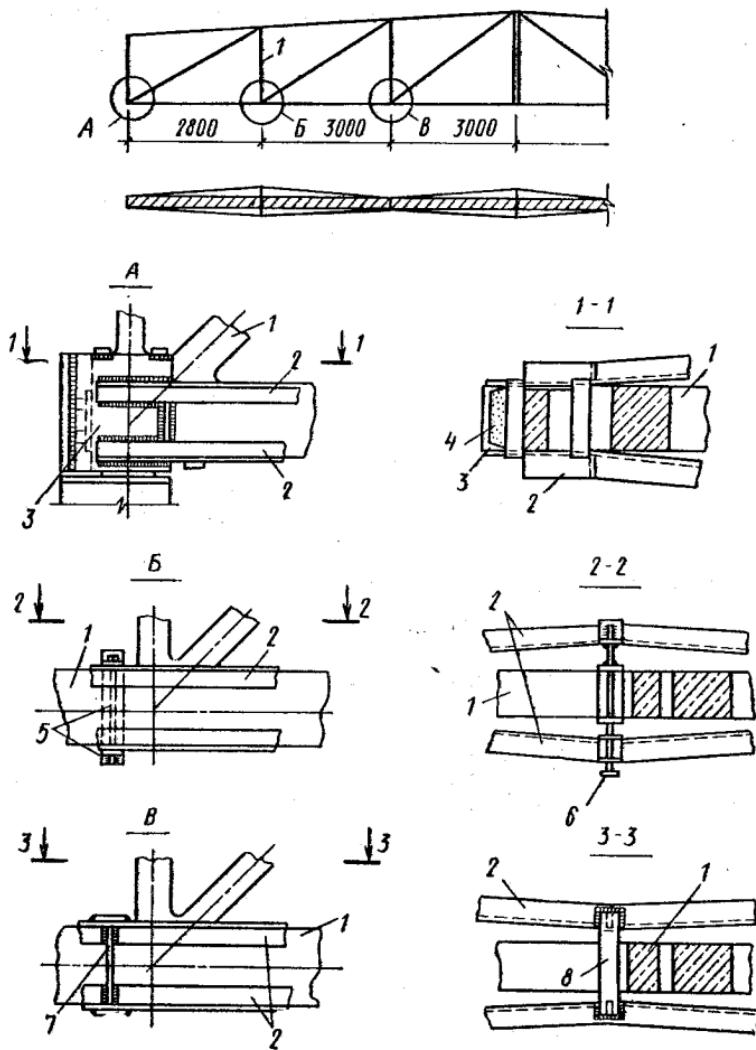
Усиление нижнего пояса ферм затяжками из уголков:
